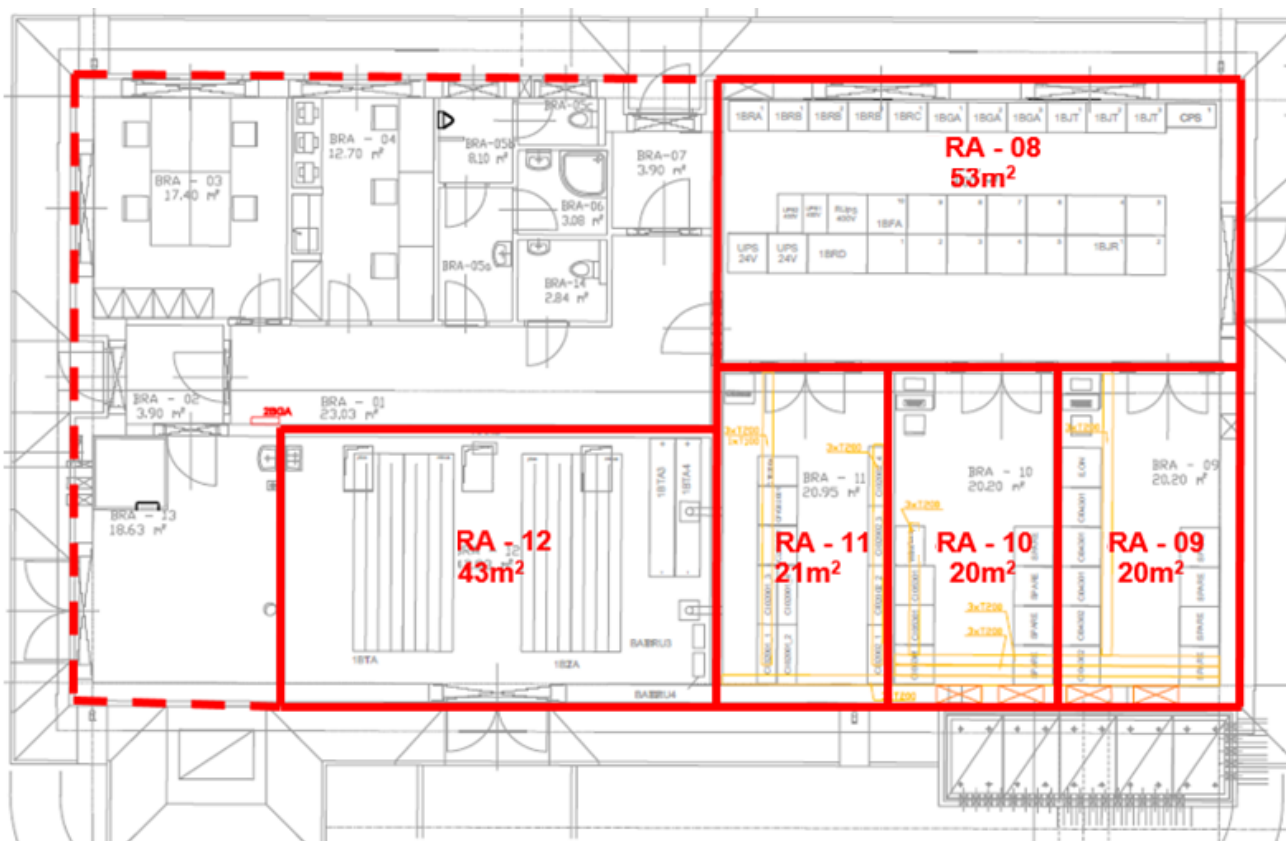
Grundriss des betroffenen Elektrogebäudes
